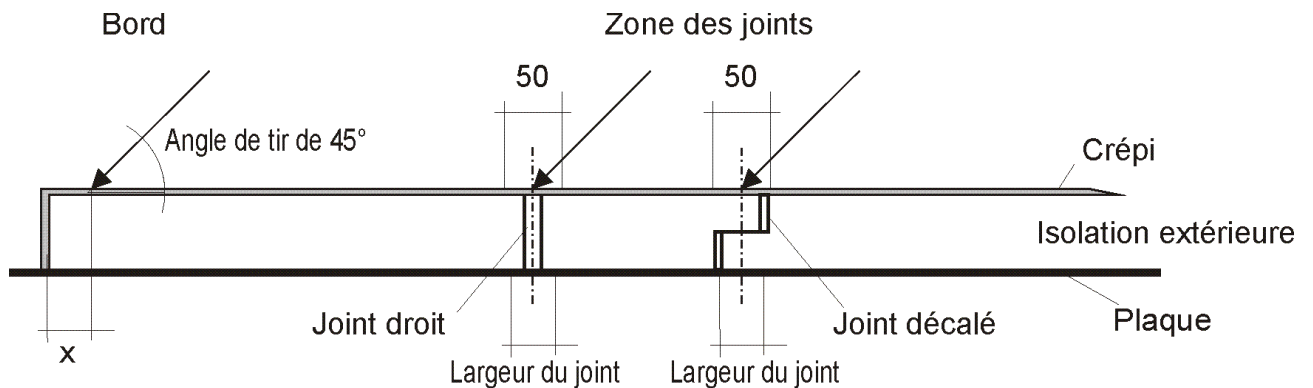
Vue de profil des points d'impact sur la zone des joints (à l'exemple d'un joint droit et d'un joint décalé) et sur le bord de l'éprouvette ($x = 1/5$ du diamètre du projectile, mesuré en millimètres)
